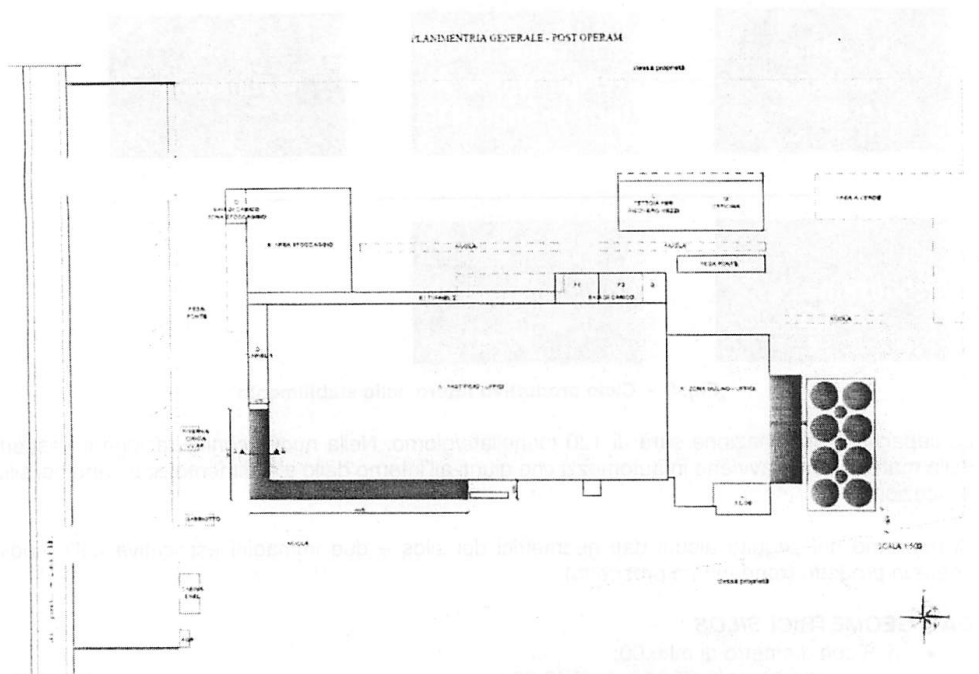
Planimetria dello stabilimento con individuazione delle nuove opere in rosso
